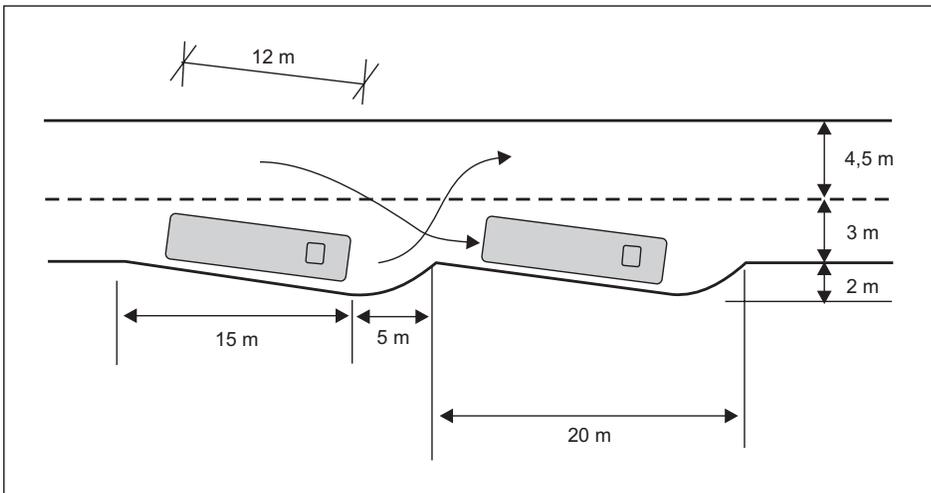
Pontos em canaletas localizadas próximo ao canteiro central e em faixas opostas com separação física. Fonte: MBB (1987).
